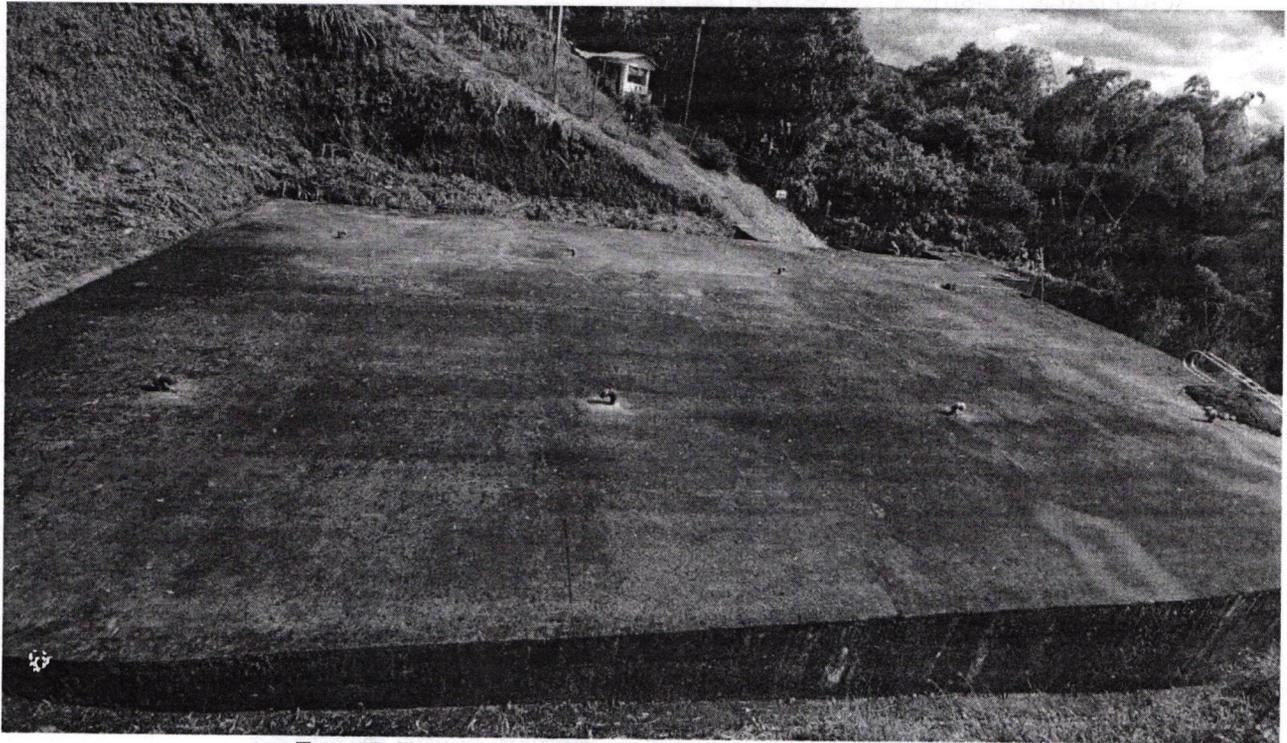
Tanque La Romelia N° 2. Vista Oeste-Este
